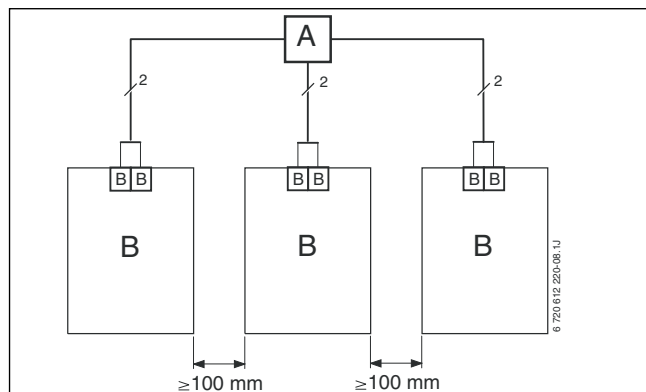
Alternativer Anschluss der BUS-Verbindungen mit Verteilerdosen
